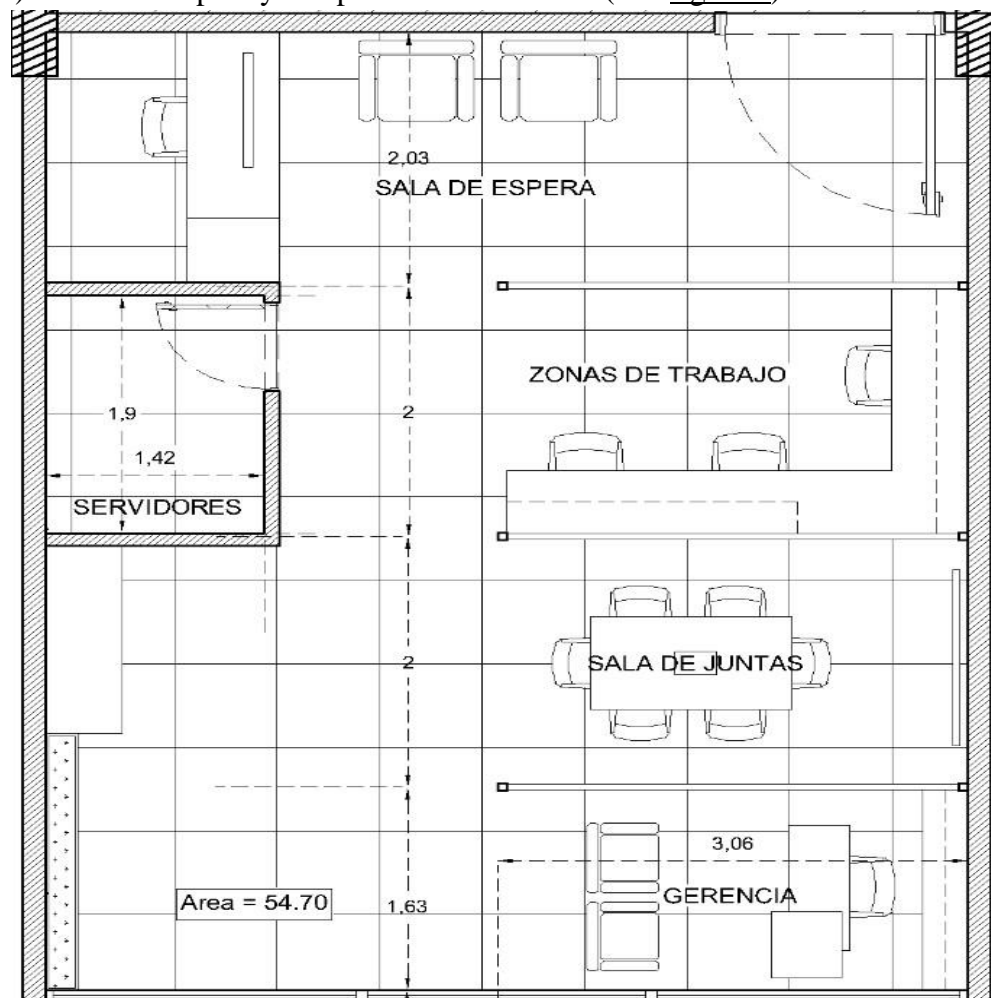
Planta arquitectónica. Fuente: elaboración propias
